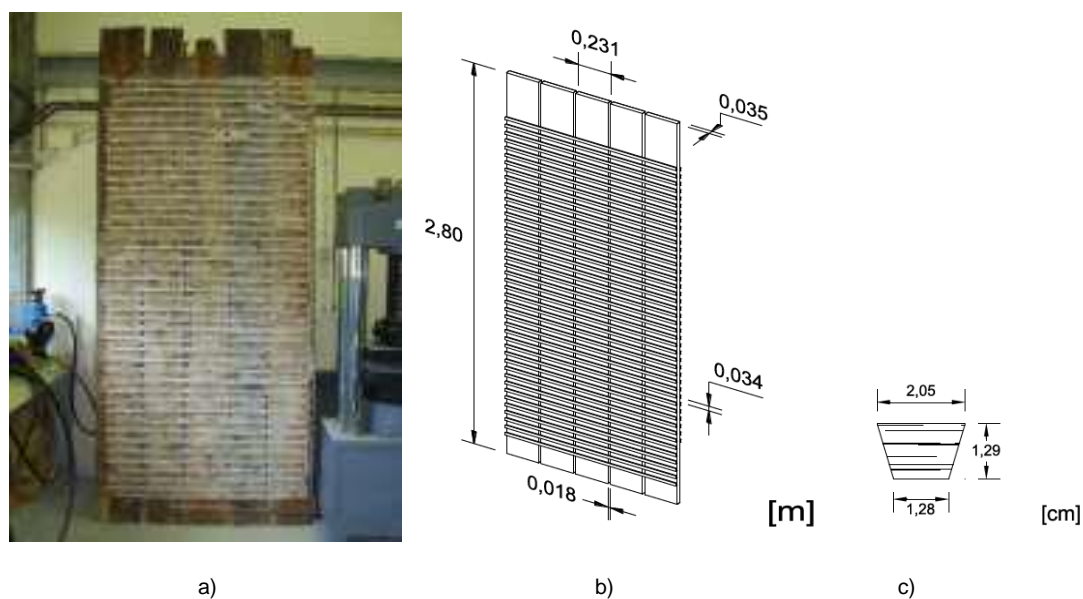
a) 1ª Parede de tabique recolhida para o ensaio – Parede de tabique simples; b) Detalhe construtivo da parede de tabique; c) Detalhe construtivo das ripas com secção transversal trapezoidal [13]
